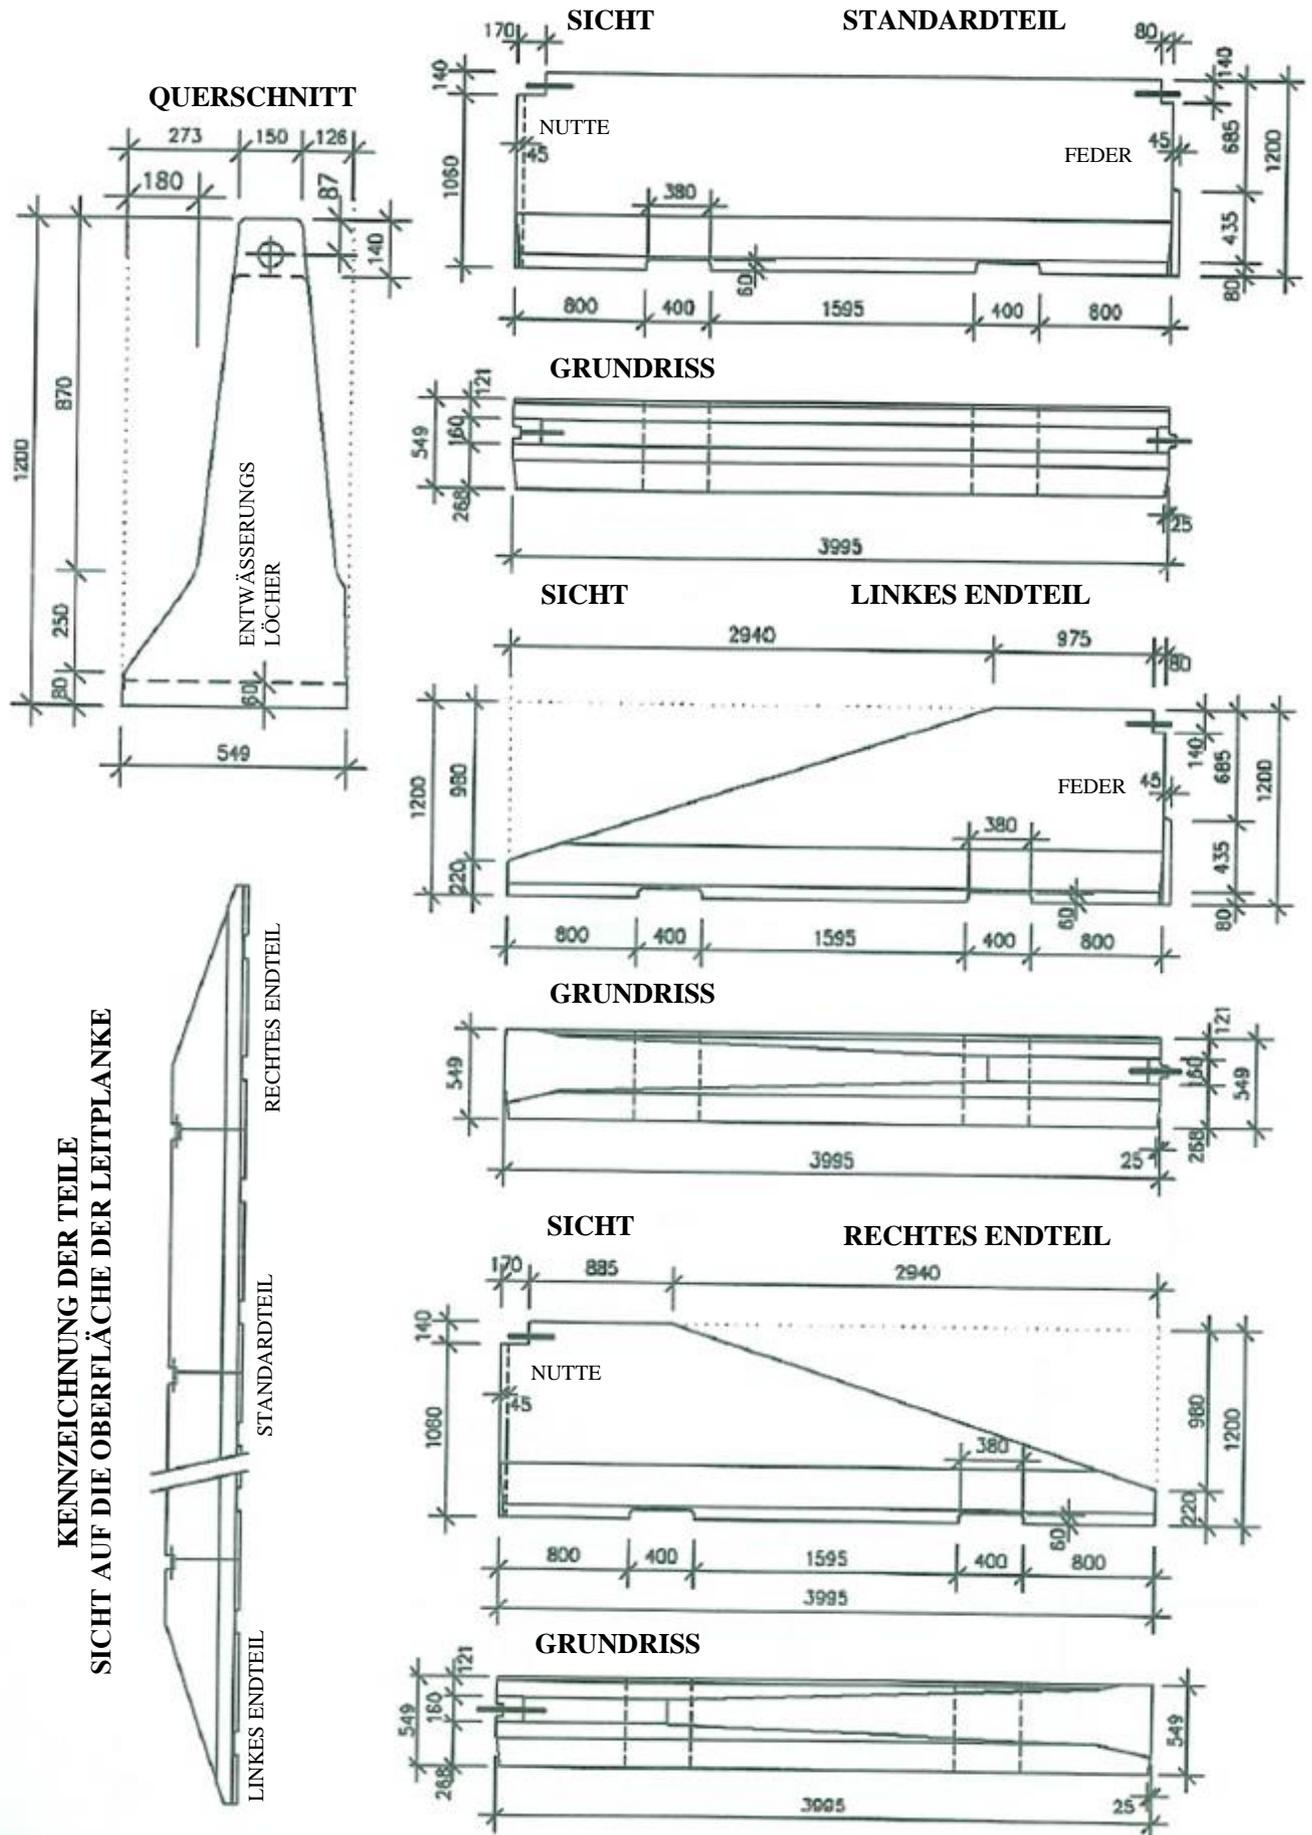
einseitige Betonleitplanke 1,2 m hoch - Standard- und Endteil
